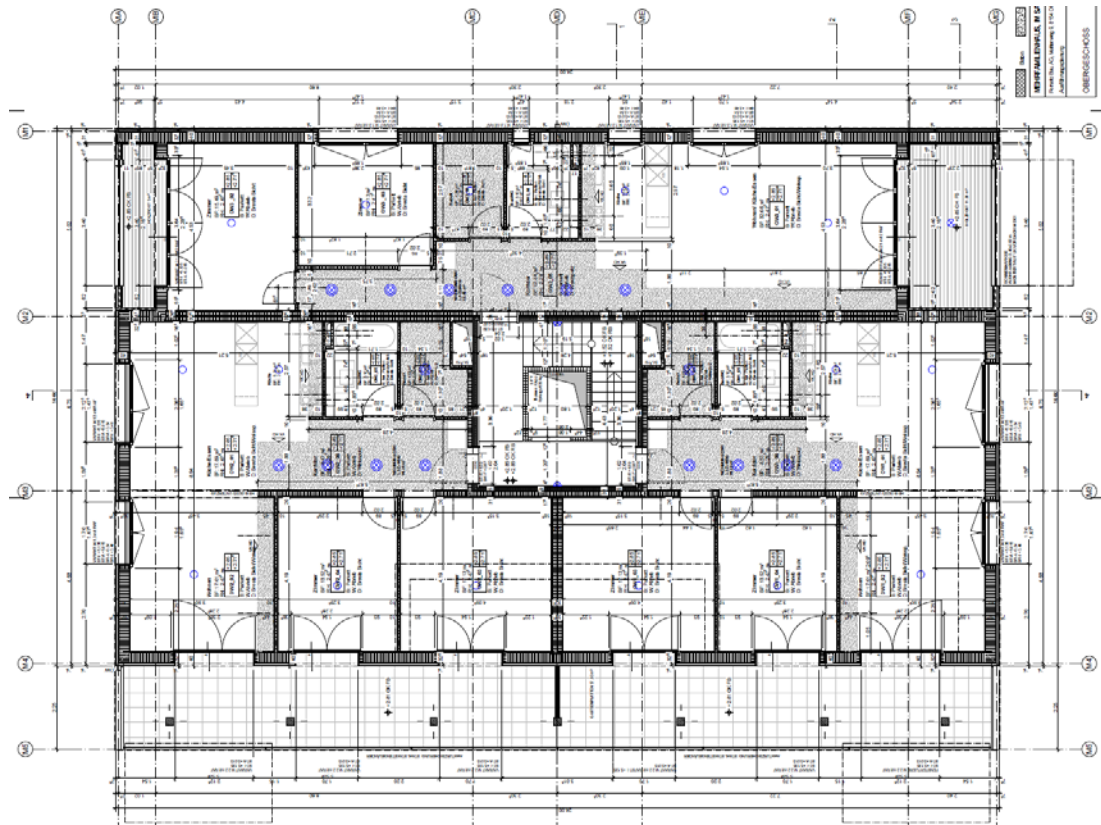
Grundriss Obergeschoss (Bild ZBF Architekten AG)
